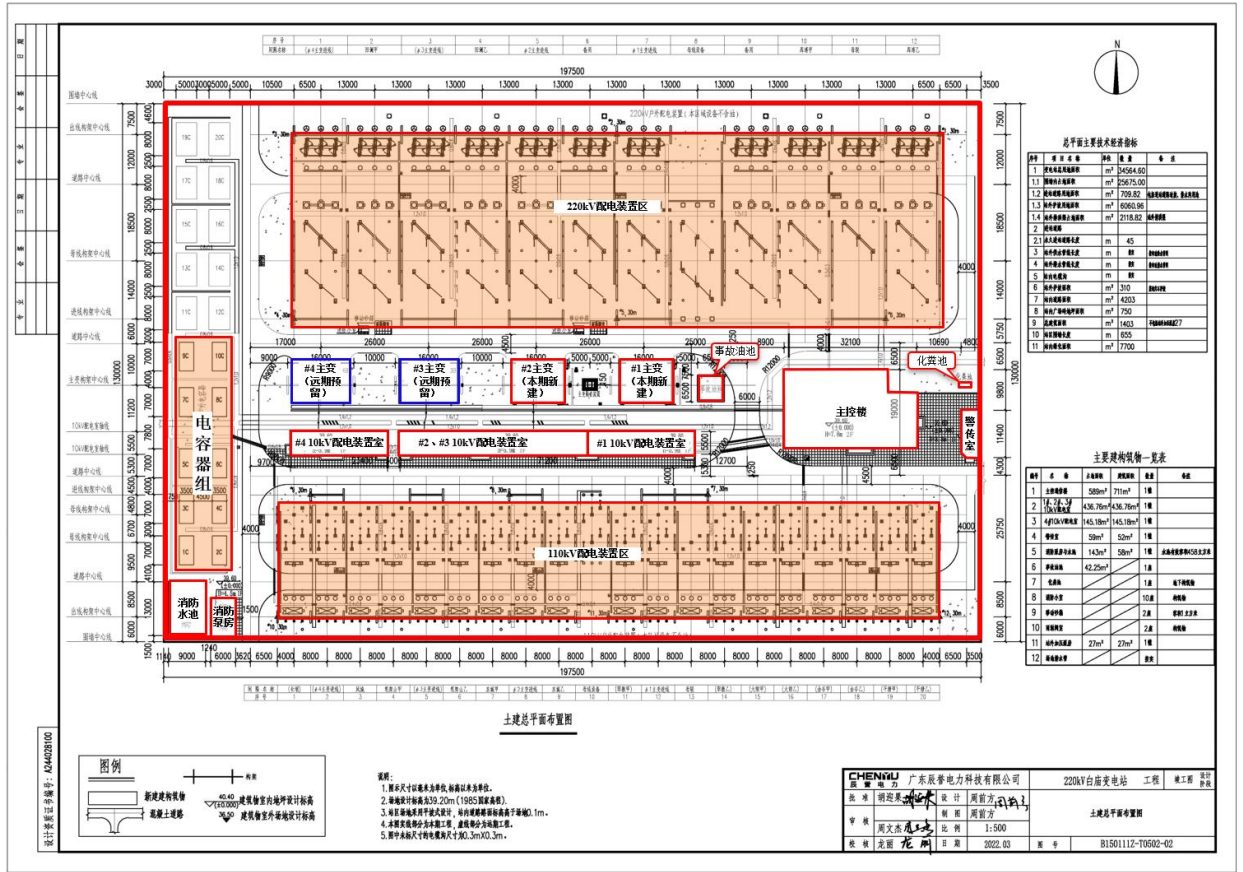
清远 220 千伏白庙（职教城）站总平面布置示意图
